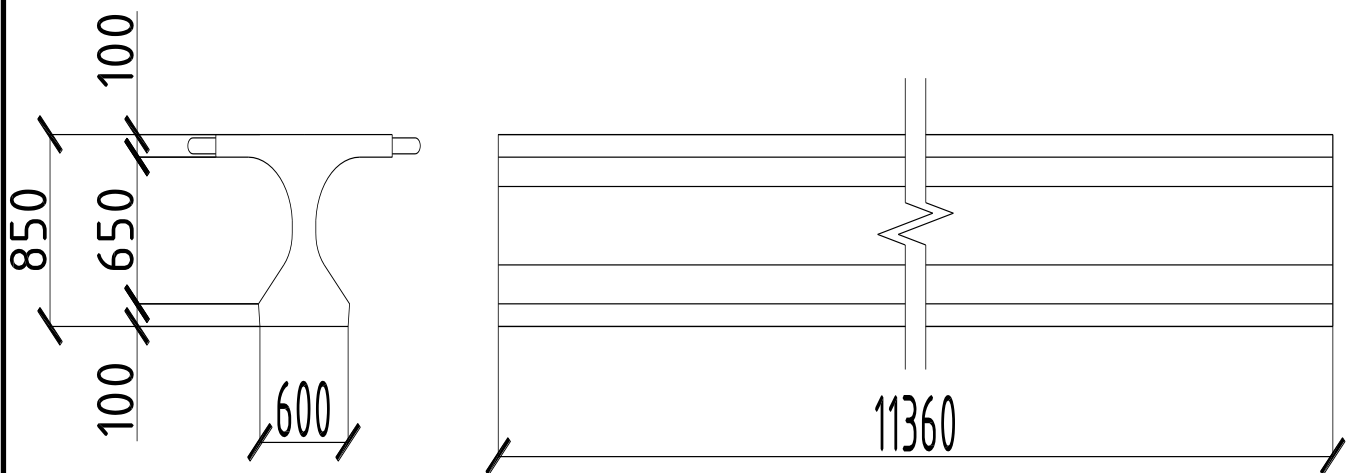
Попередньо напружена залізобетонна балка
